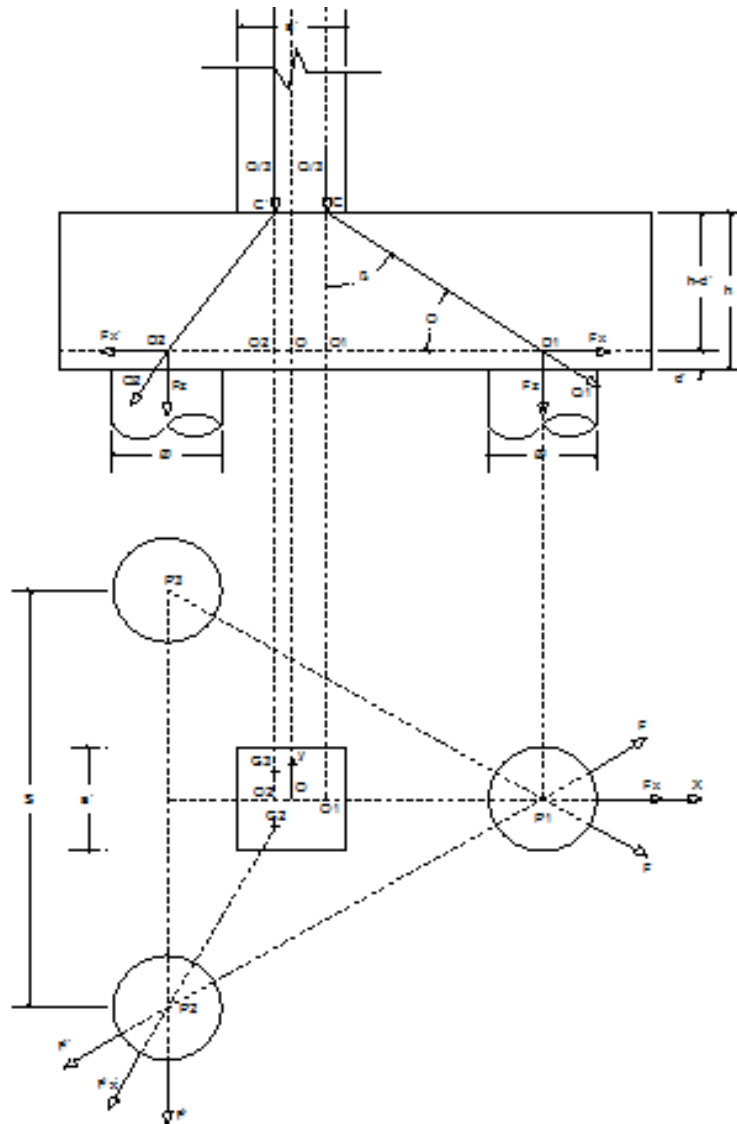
18: Método de las bielas para cabezales sobre tres pilotes-columna cuadrada.
